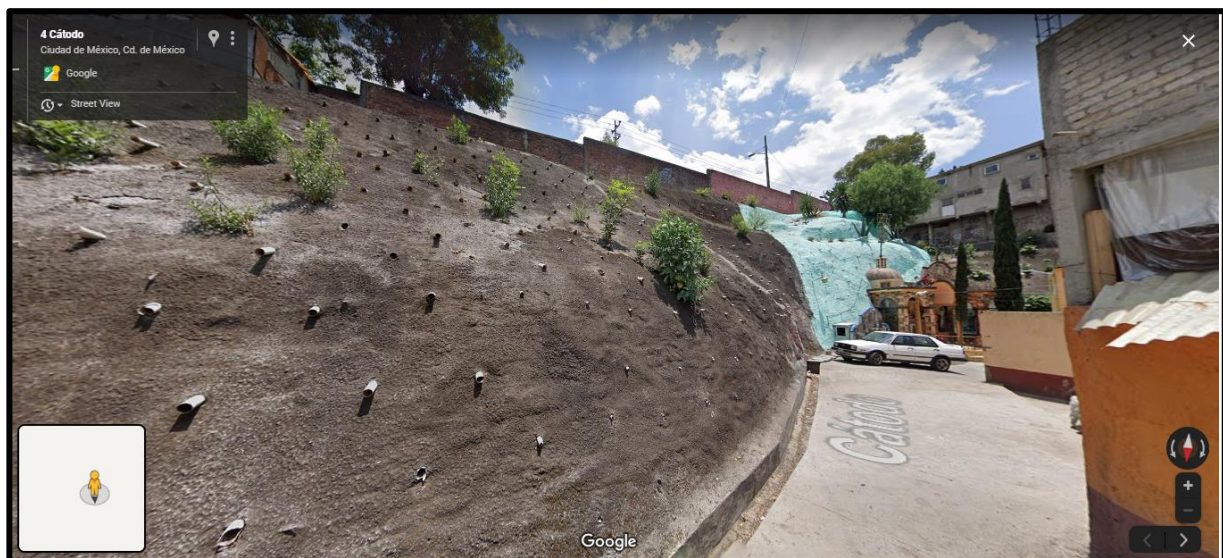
Vista del talud hacia el lado SW, donde se señala la grieta.
